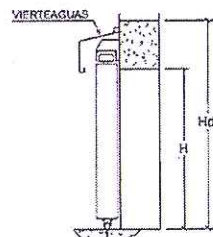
Detalle de sección vertical de puerta industrial corrediza apoyada
